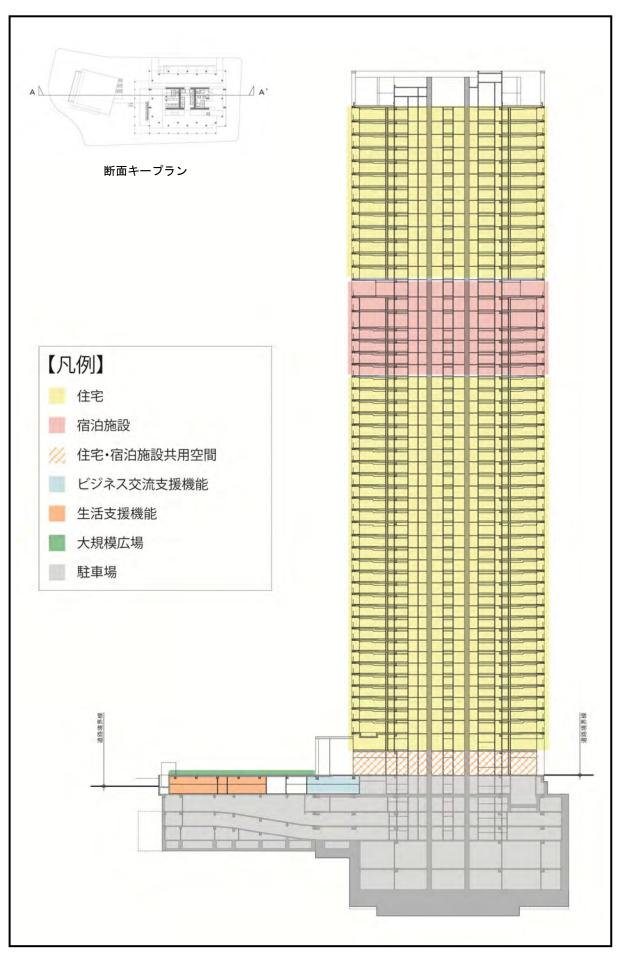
(1) 断面図 (A-A'断面 S=1:1,200)【変更前】
